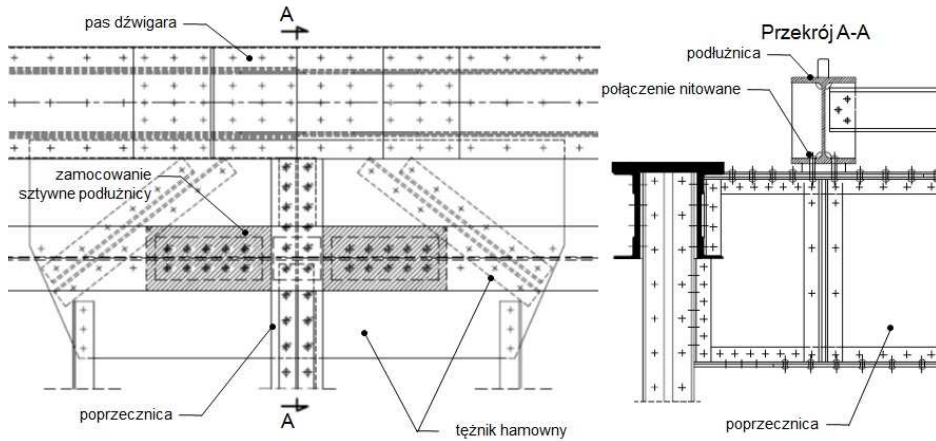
Konstrukcja pomostu w przęsłach typu B po remoncie
